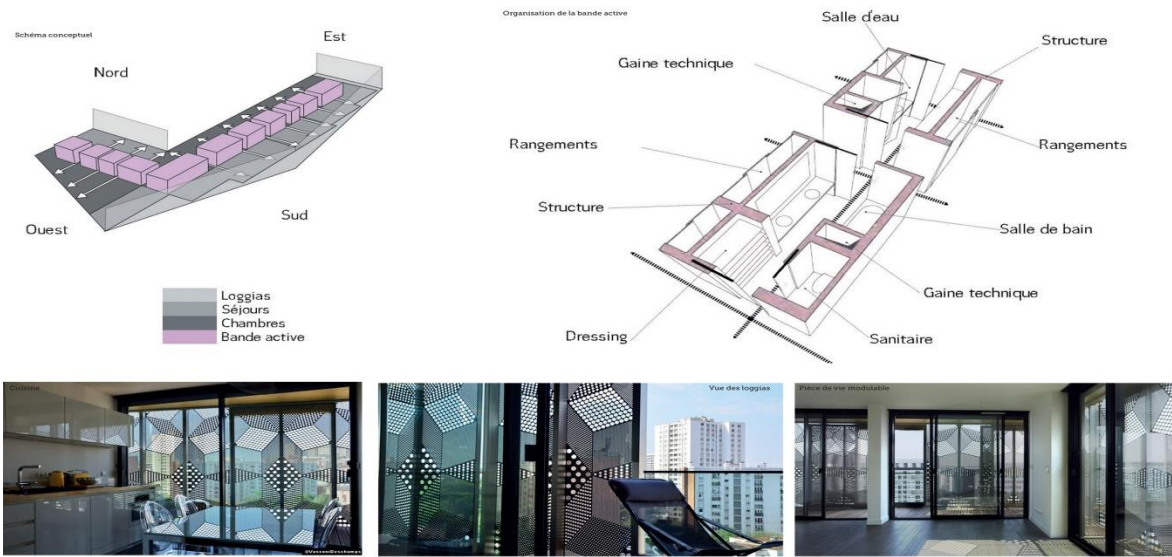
Schéma de distribution fonctionnelle d'un étage de logement
